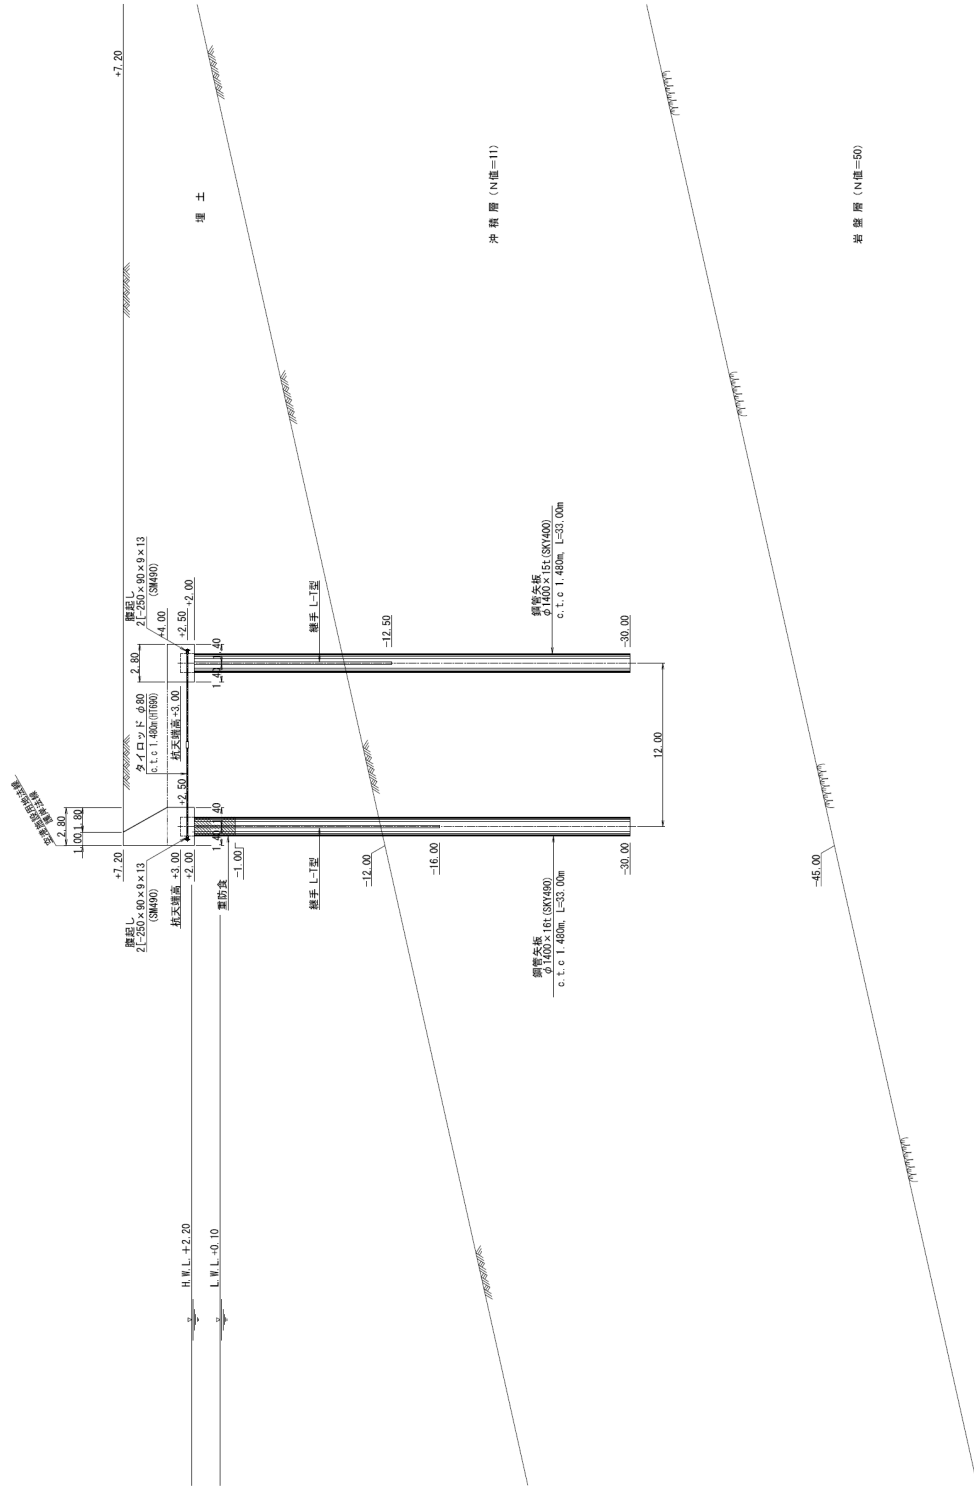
代替施設本体の二重縮切矢板式護岸断面図
